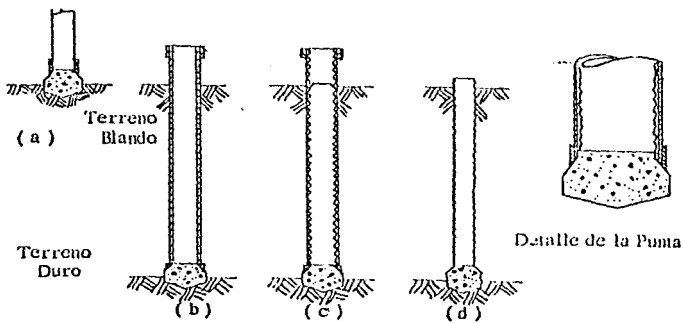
PILOTE BUTTON-BOTTOM.
